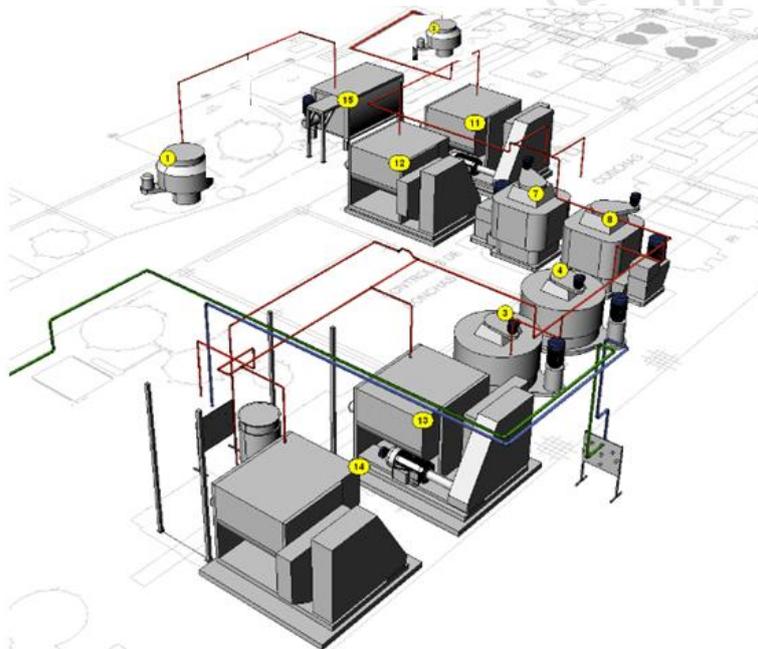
Ruta de tuberías en llegada a las conchas.
